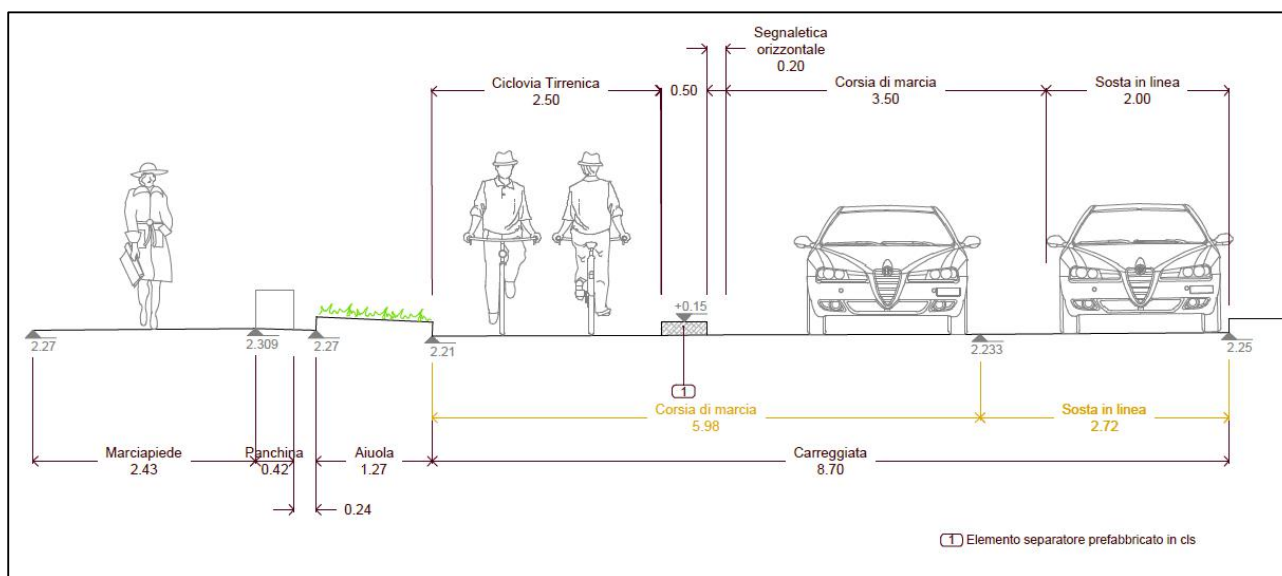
Sezione 08 di progetto trasversale su Viale Carducci
